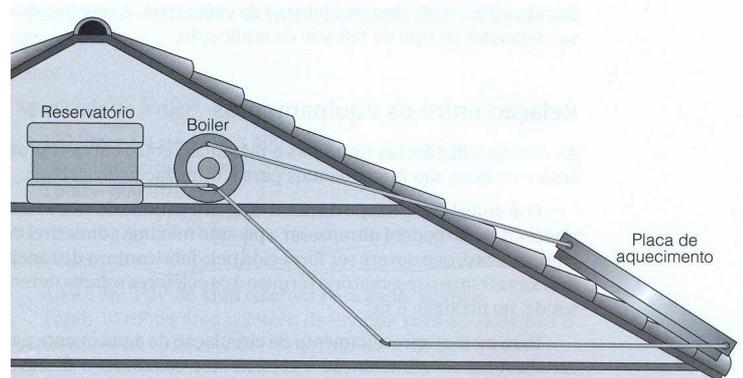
Boiler solar instalado ao lado do reservatório.
